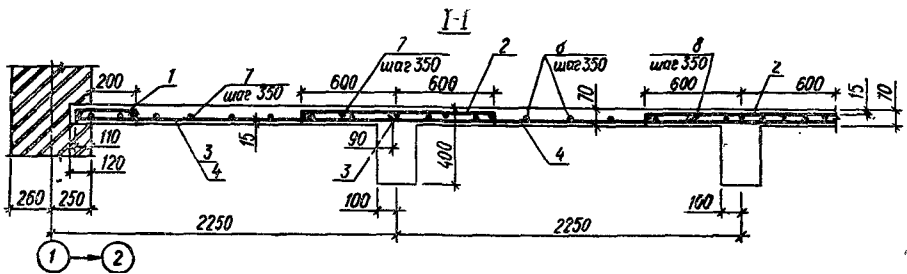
Армирование плиты ребристого перекрытия отдельными стержнями.
